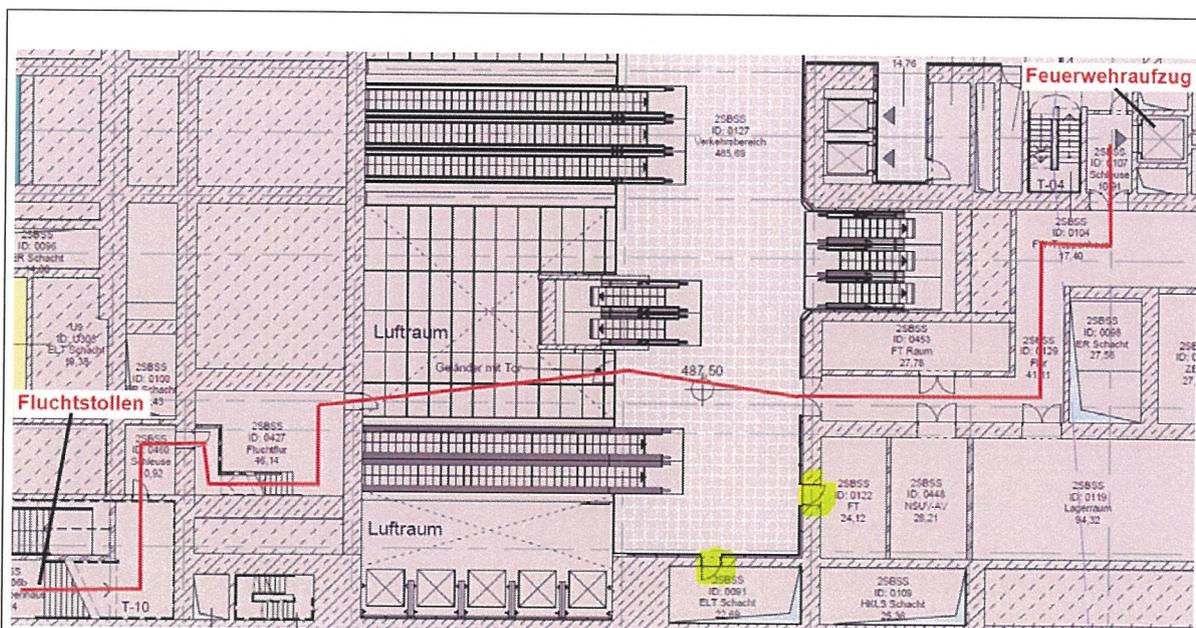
Laufweg in uPva MHPB vom westlichen Fluchtstollen zum Feuerwehraufzug (Grundriss, Prinzip)
